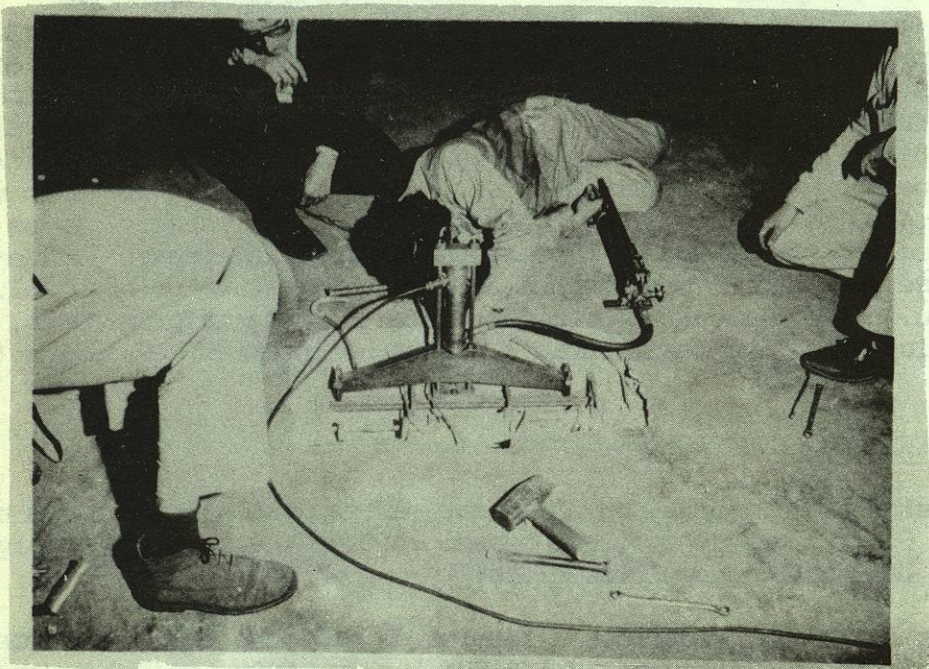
Aparato construido para medir la tensión en los cables de las vigas postensionadas.
